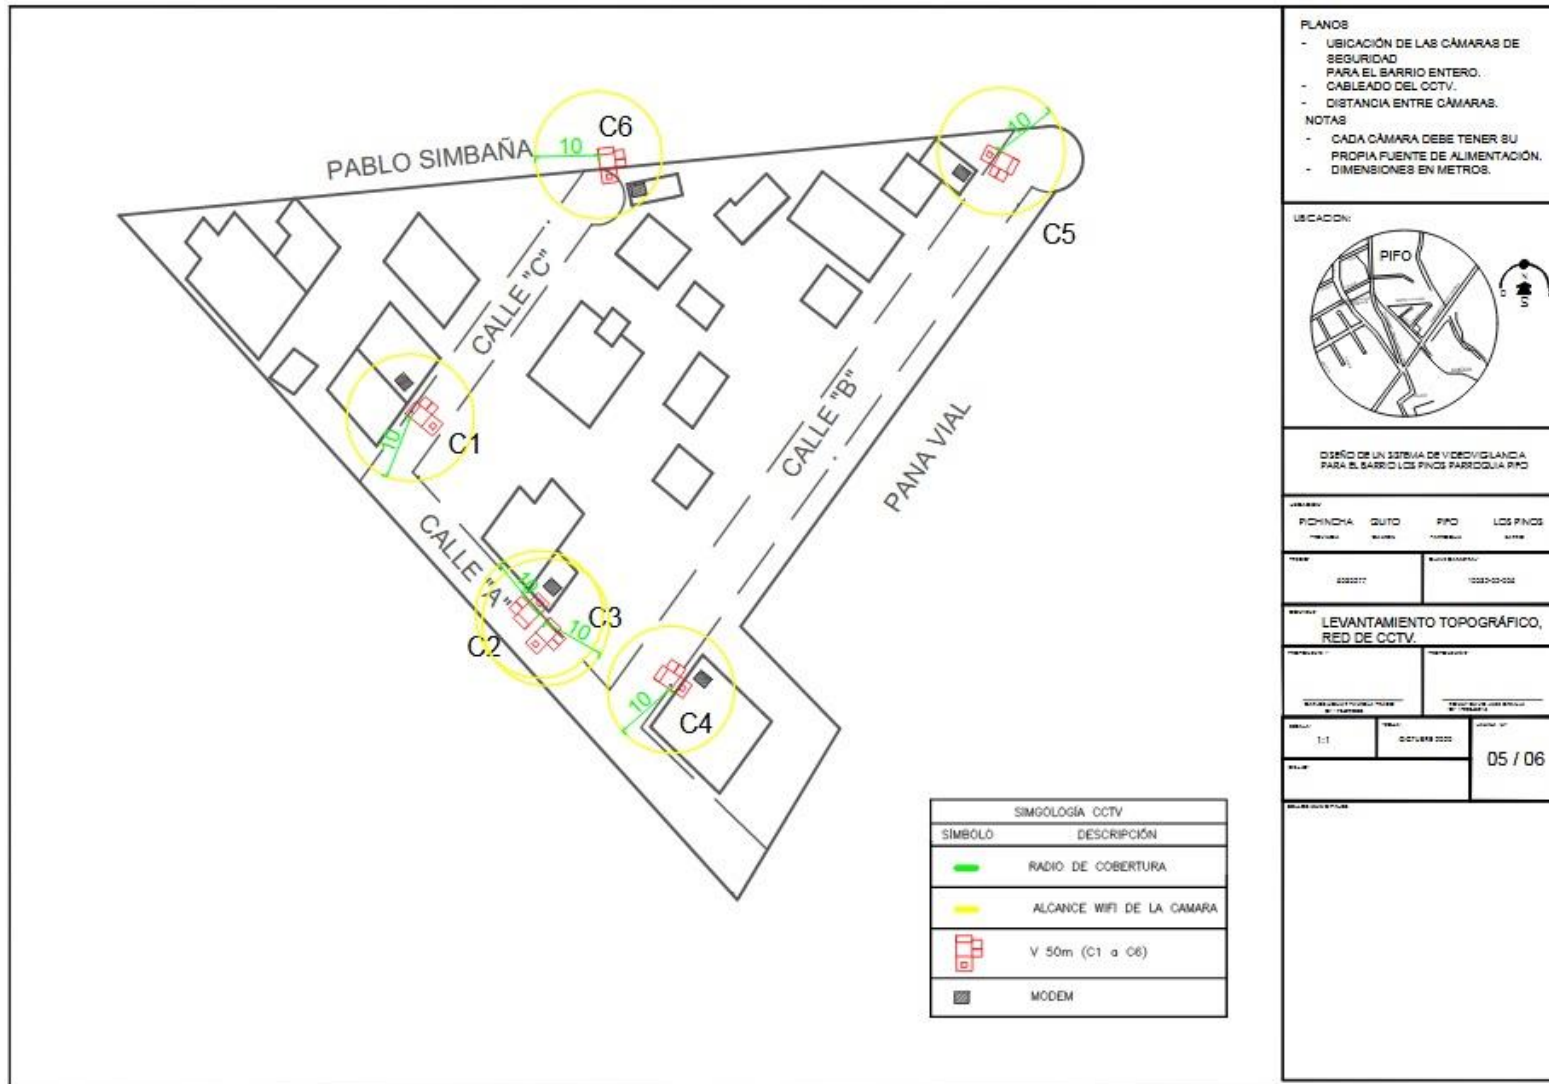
Plano ubicación de cámaras diseño inalámbrico
